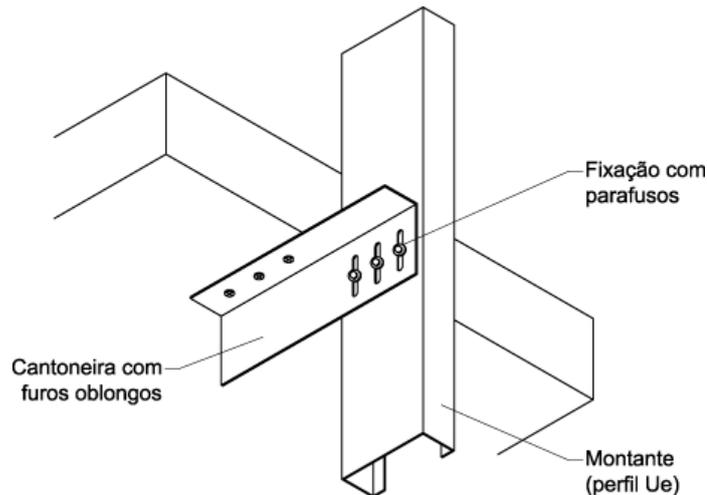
Cantoneira de movimentação fixada à face inferior da estrutura
